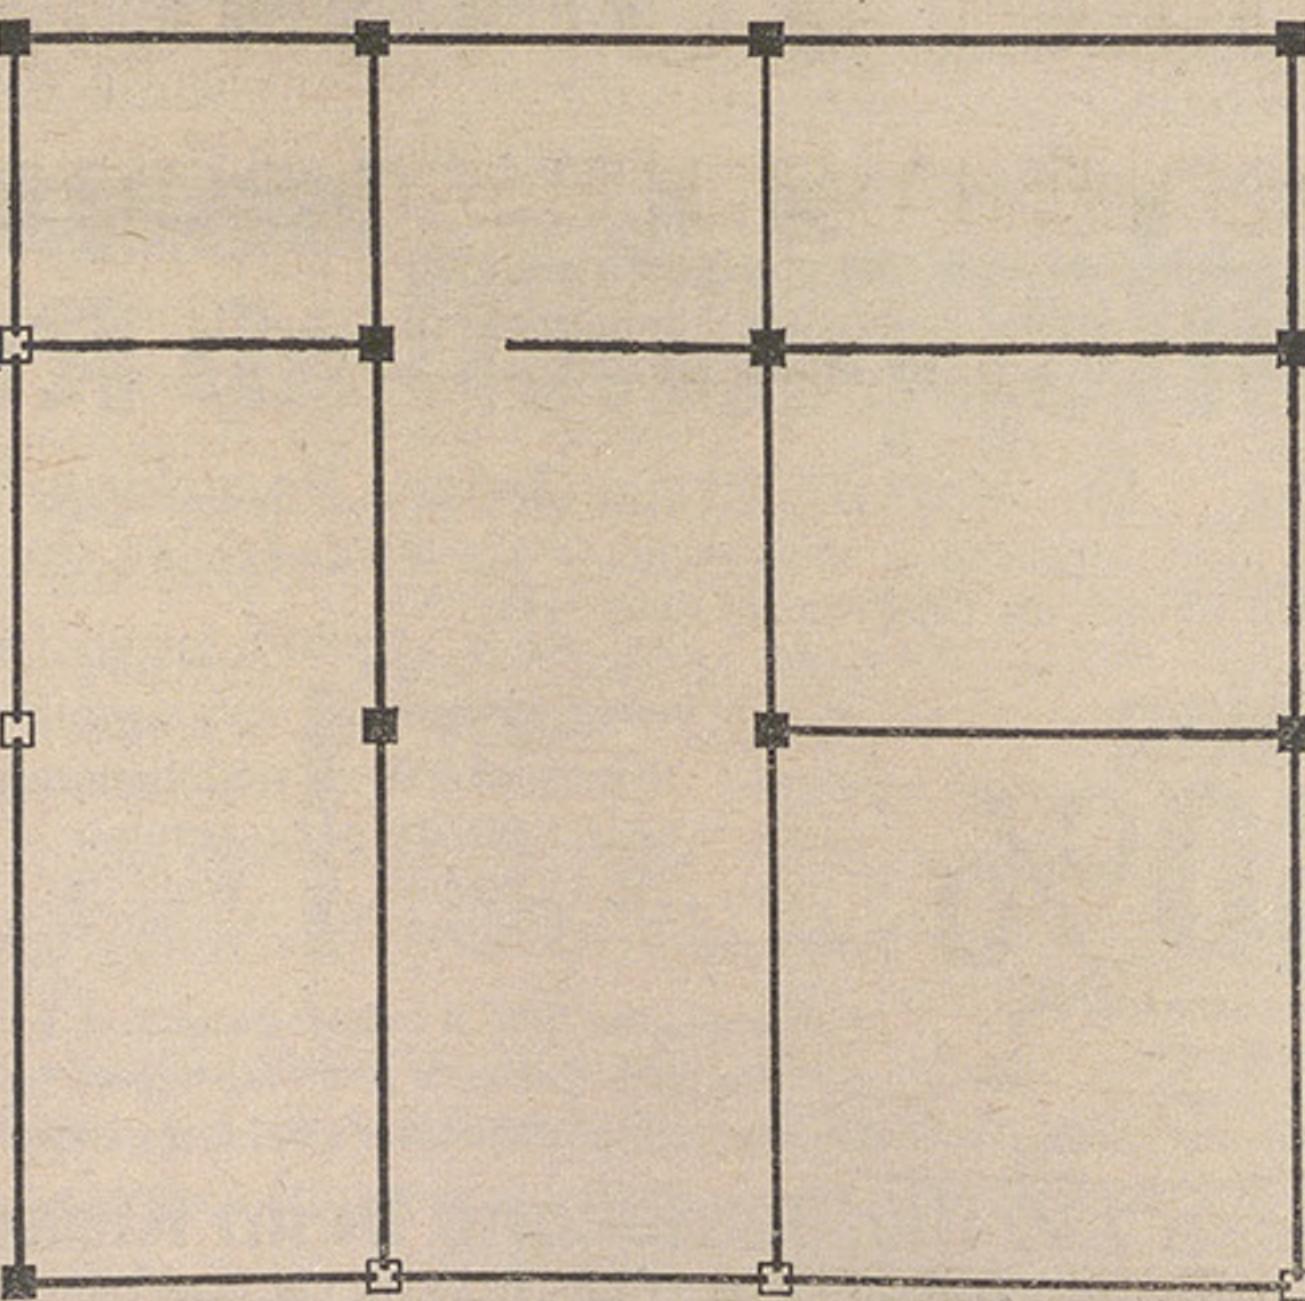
Grundriss vom Ständergerüst mit Bohlenwänden im 1. Stock des ursprünglichen Lehenhauses; vgl. Abbildungen 8 bis 13. □ Ständer ergänzt.
